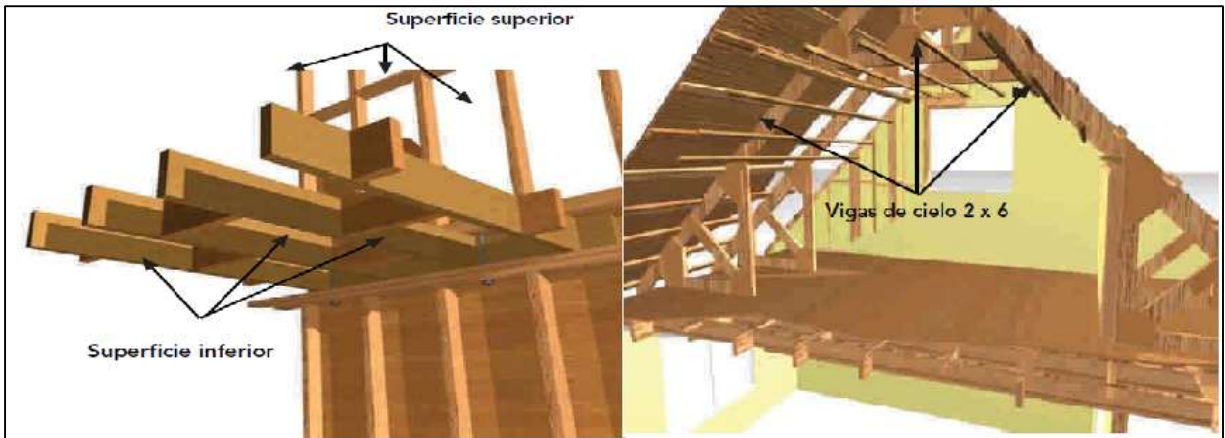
Vigas de entepiso (izquierda) y vigas de cielo (derecha). (Fuente: La construcción de viviendas en madera. CORMA; 2013: 187, 188)
